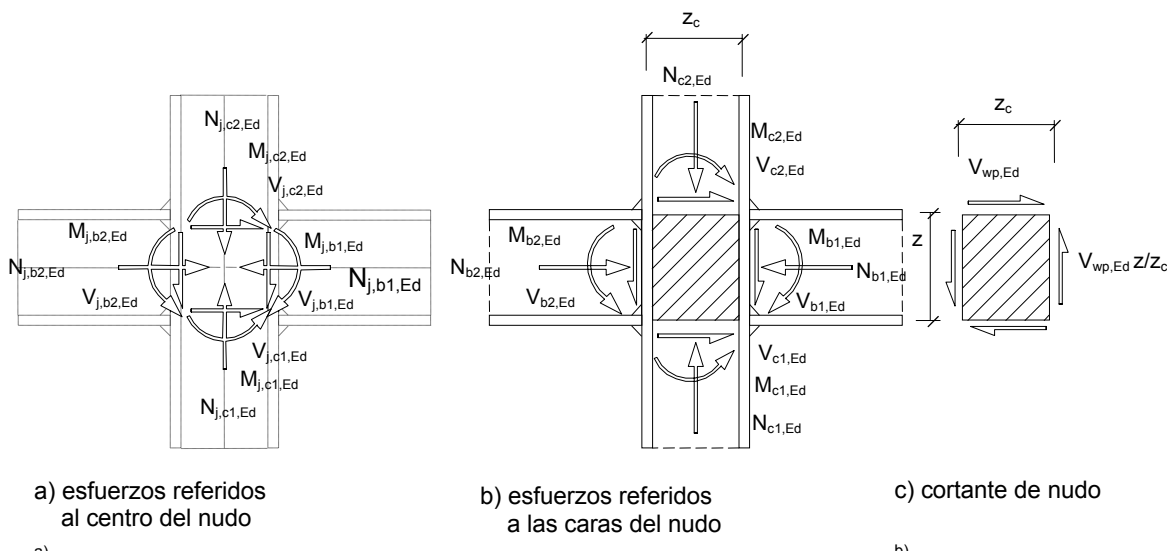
Unión (soldada o atornillada) y cortante de nudo
